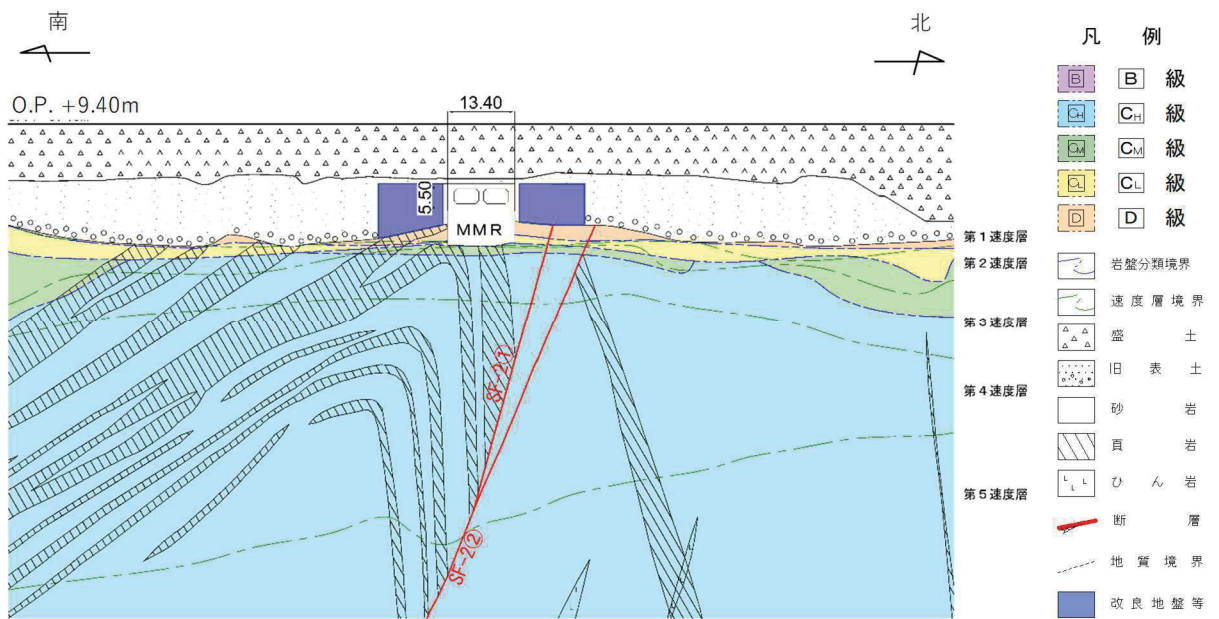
(2) 取水路の地質断面図 (㉔-㉔断面)
